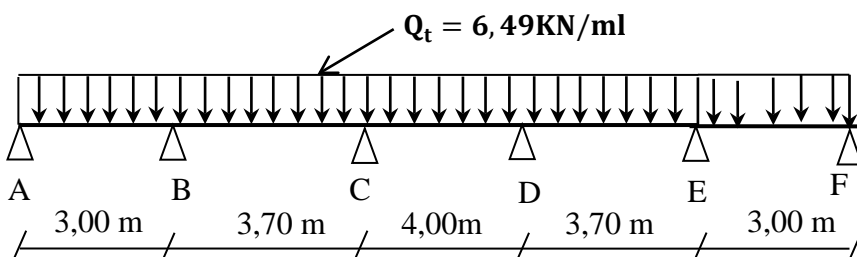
Poutrelles à 5 travées (plancher terrasse)
